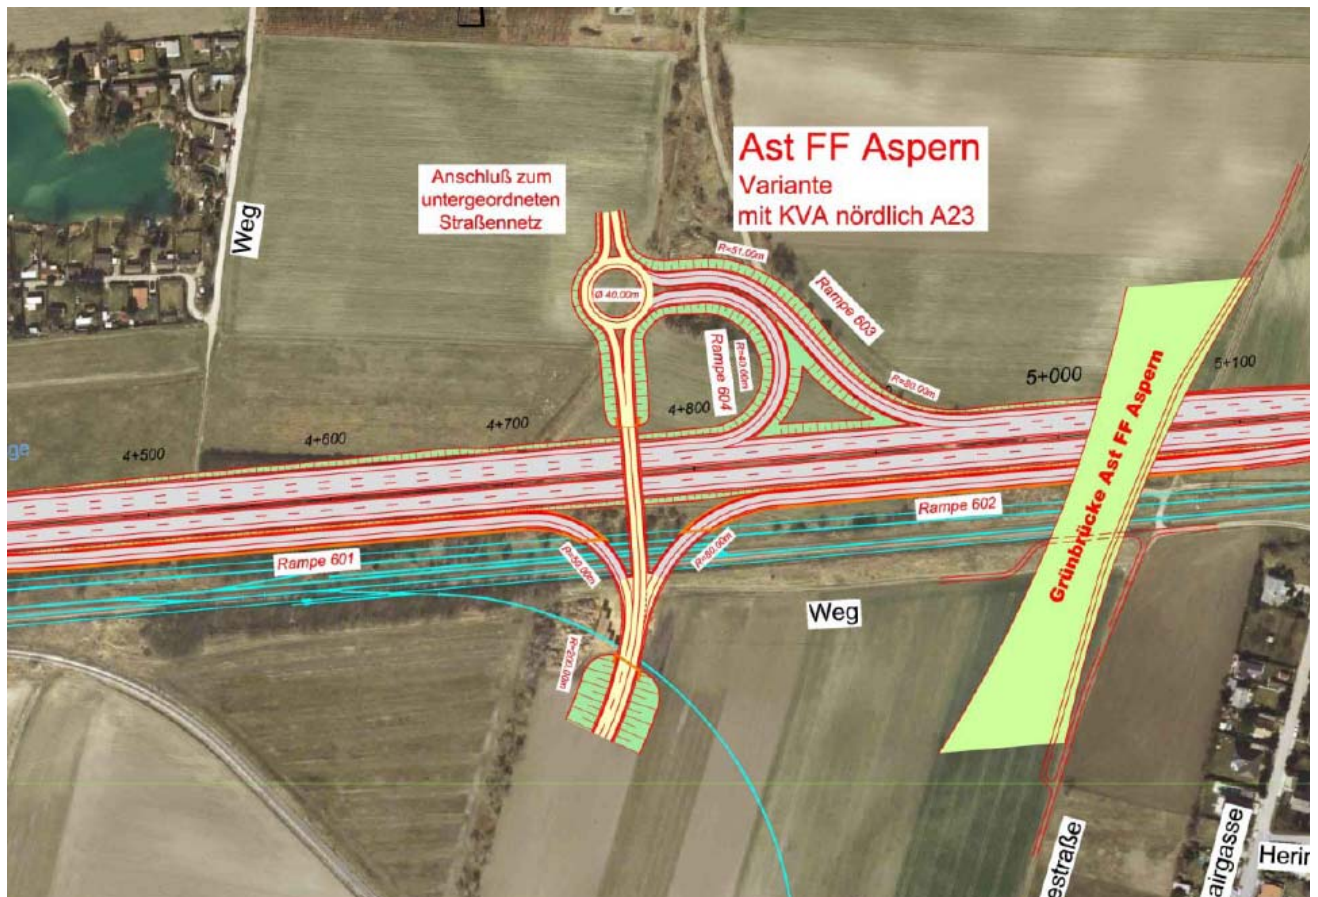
Ausschnitt Lageplan – Technisches Projekt, Einreichprojekt S 1 Spange, Quelle: Werner Consult / IKK
